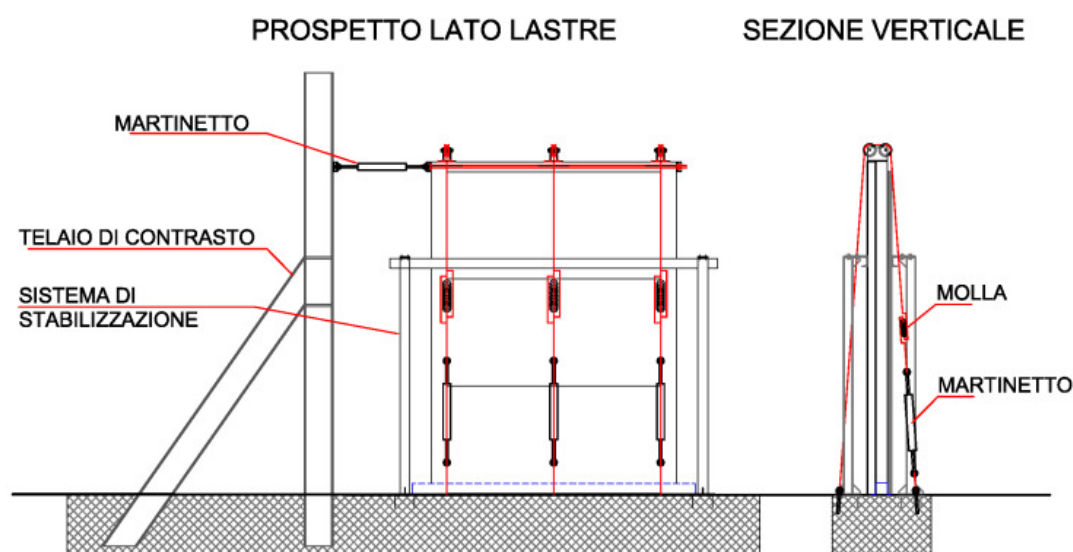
Allestimento della prova – prospetto e sezione verticale.
